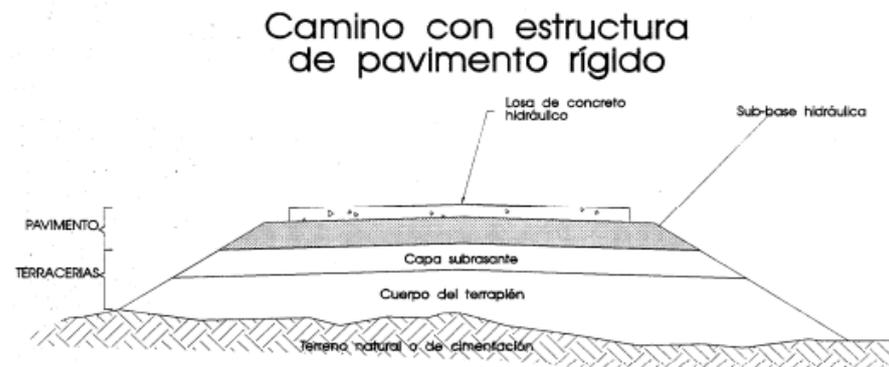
Esquema de un pavimento Rígido. Fuente: <http://tesis.uson.mx/digital/tesis/docs/2944/capitulo2.pdf>
